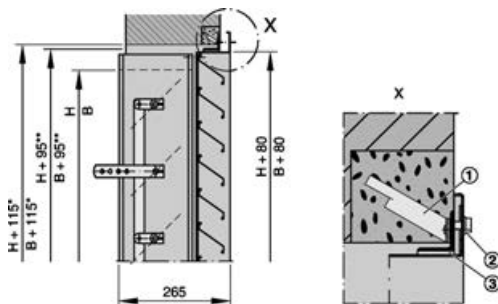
Installation murale avec la prise d'air extérieure (WG-JZ)
